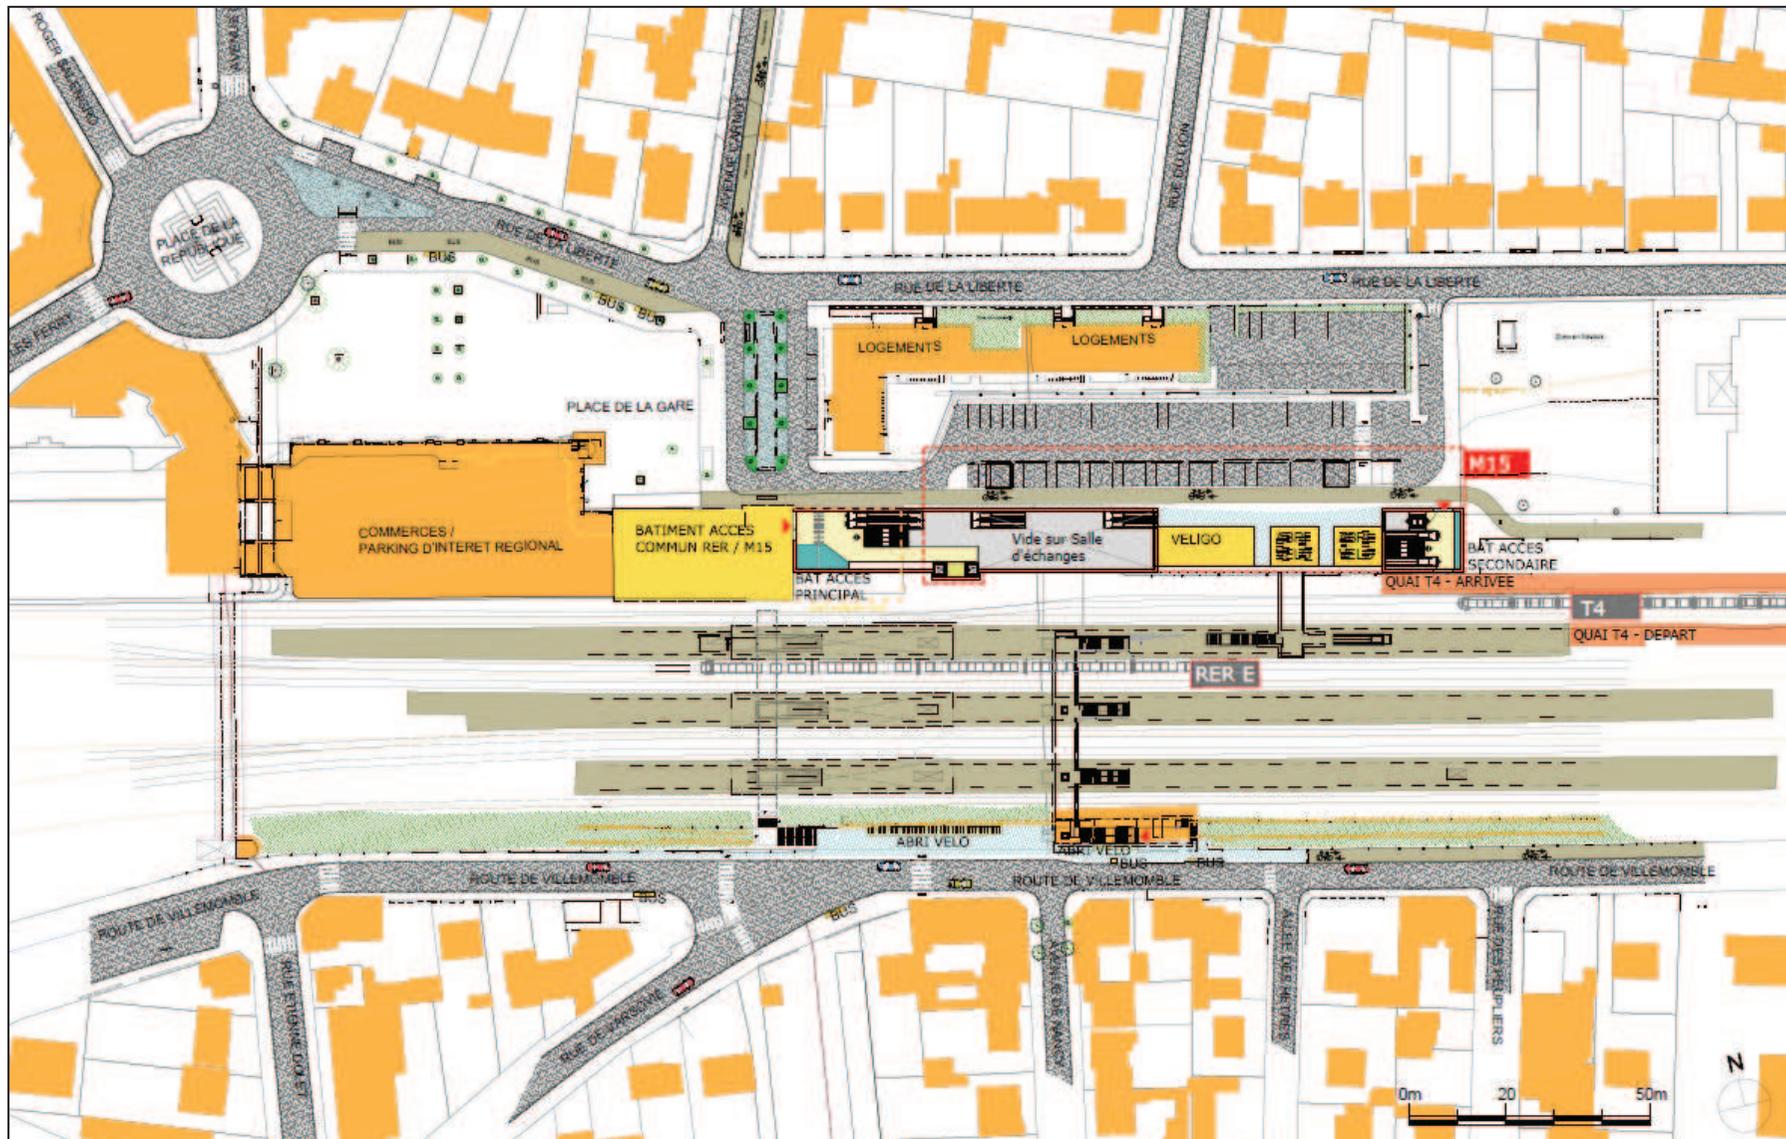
Vue en plan générale Bondy (Source : STIF)
